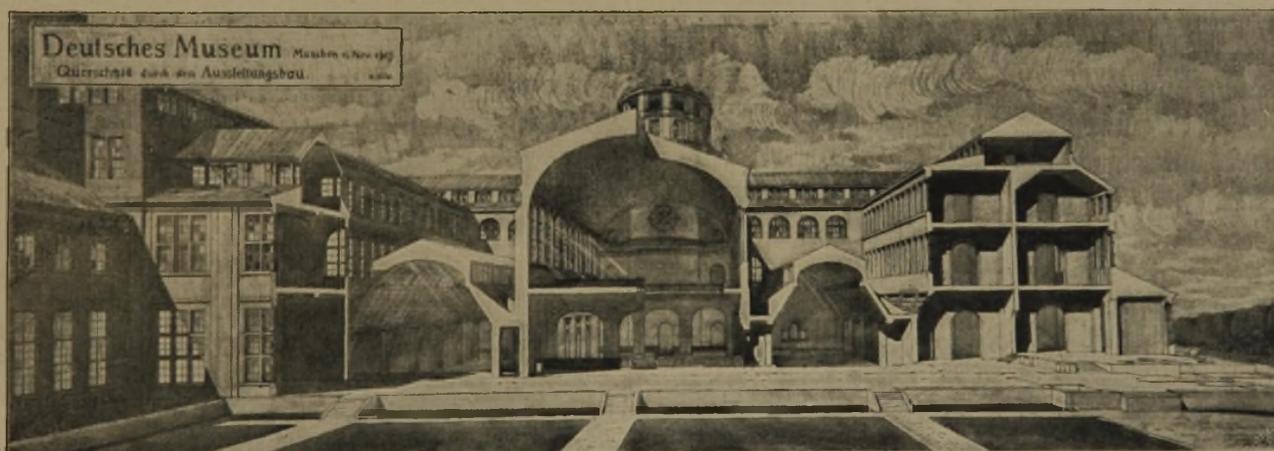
Schnitt durch den Ausstellungsbau nach dem Ausführungs-Entwurf.
